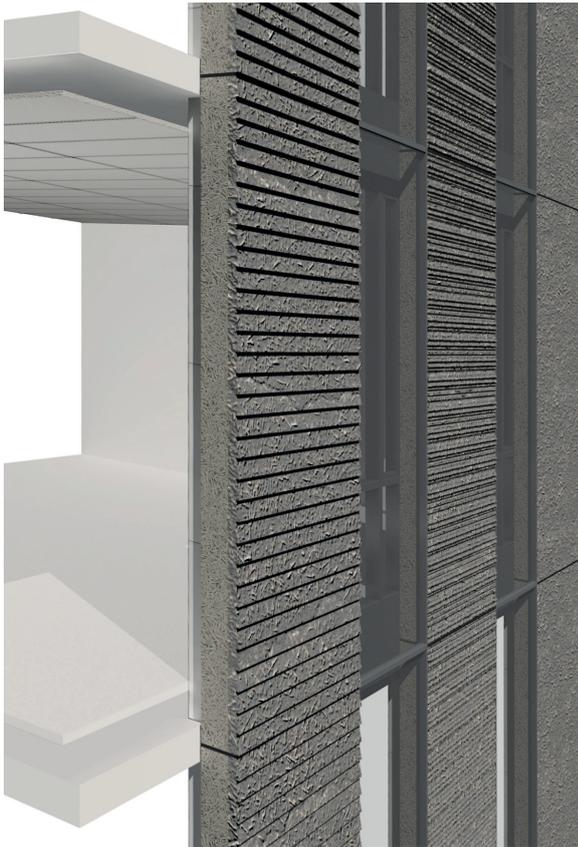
Holzleichtbeton Fassadenelemente mit unterschiedlichen Oberflächenstrukturen
